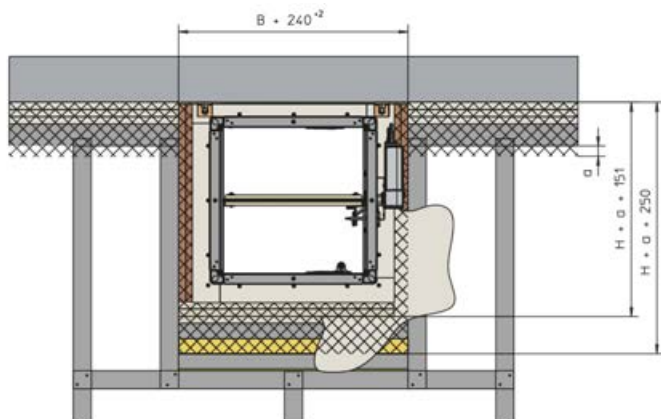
Installazione a secco in una parete divisoria leggera, con collegamento flessibile al soffitto e kit d'installazione GLK..., installazione di due serrande tagliafuoco FK2-EU di uguale altezza ( $B \leq 600$  mm) fianco a fianco in un'apertura di installazione
